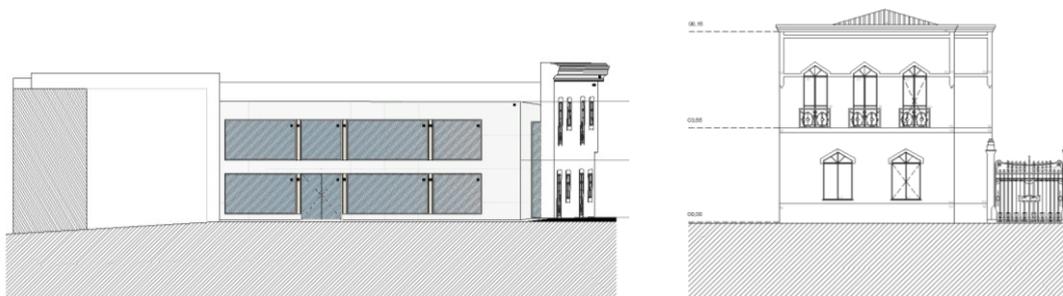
Proposta de Alçados \_ Alçado Poente (Entrada Principal) | Alçado Norte (Entrada secundária)
